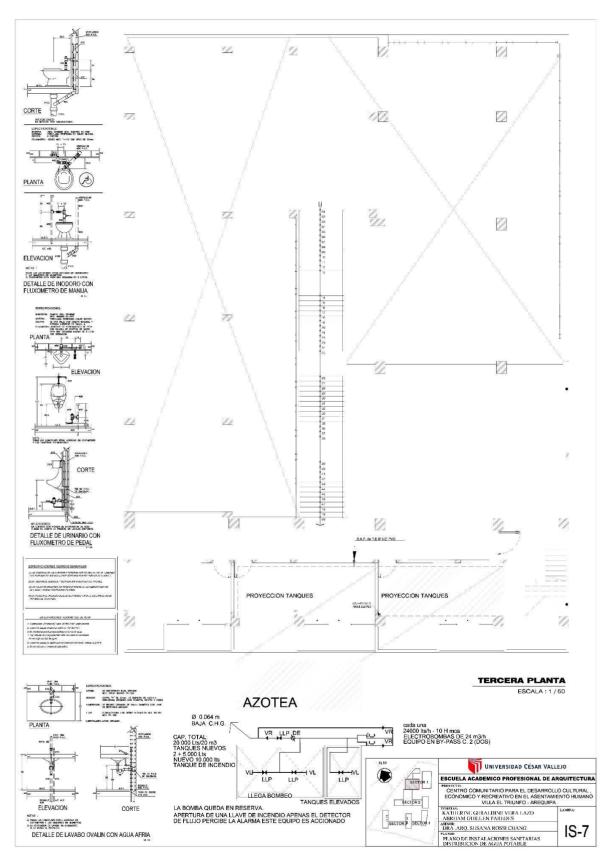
Planos de distribución de redes de agua potable Tercera Planta - Elaboración propia
